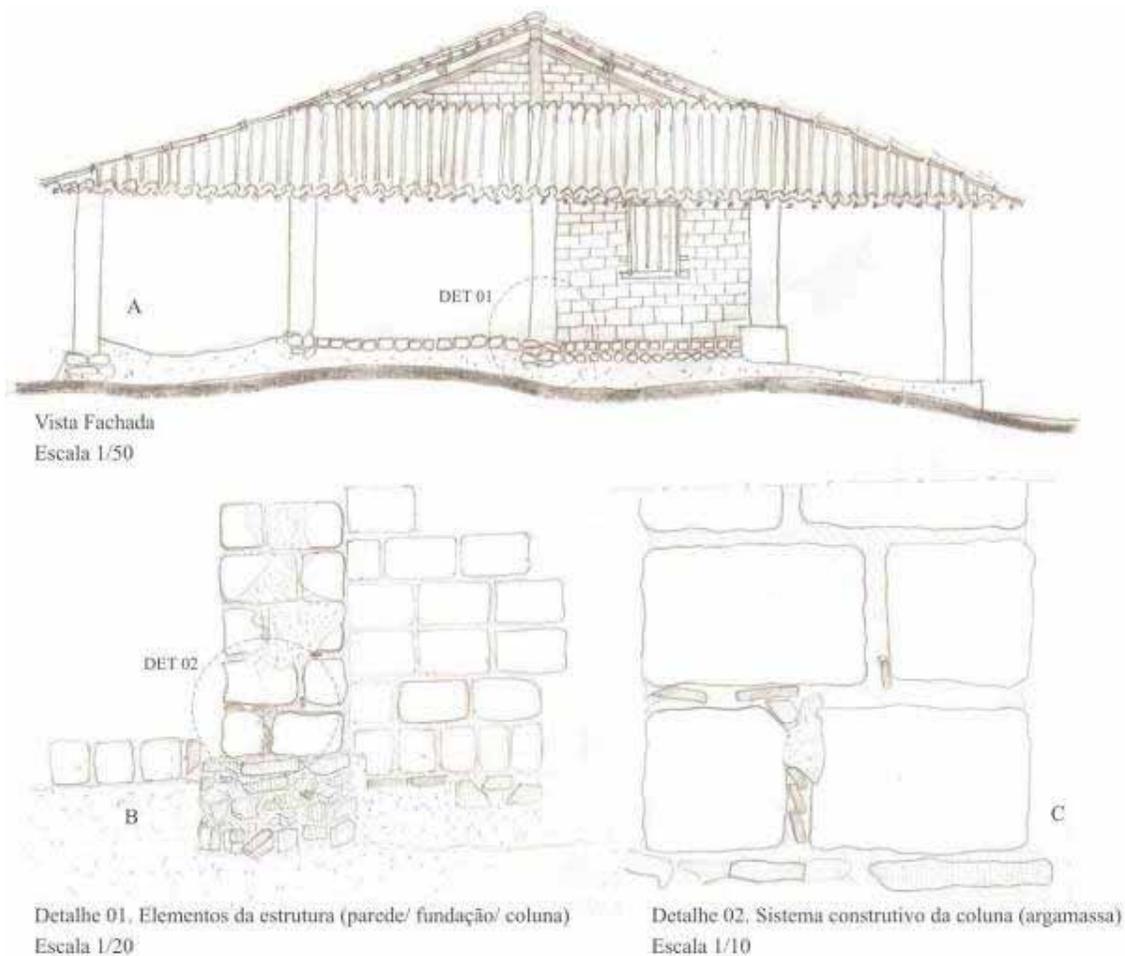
Exemplificação da diferença entre a capacidade de evidenciação das escalas. Desenho A: escala 1/50 evidenciando a fachada completa, os espaços e a estrutura e seus elementos; Desenho B: escala 1/20 evidenciando os elementos da estrutura e sugerindo os sistemas construtivos; Desenho C: escala 1/10 evidenciando os sistemas construtivos (alvenaria de adobe) e seus materiais constituintes (adobe e argamassa de barro com fragmentos de telha cerâmica). Fonte: arquivo da Fundação Seridó. Sítio Arqueológico Benedita no município de Nazaré/BA (Desenho: Autora).
